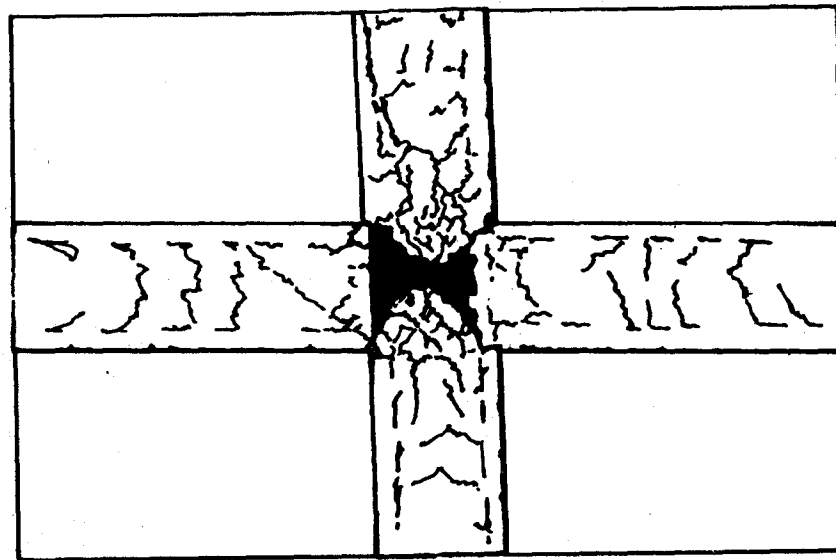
Comportamiento idealizado de una unión viga-columna exterior de concreto reforzado
